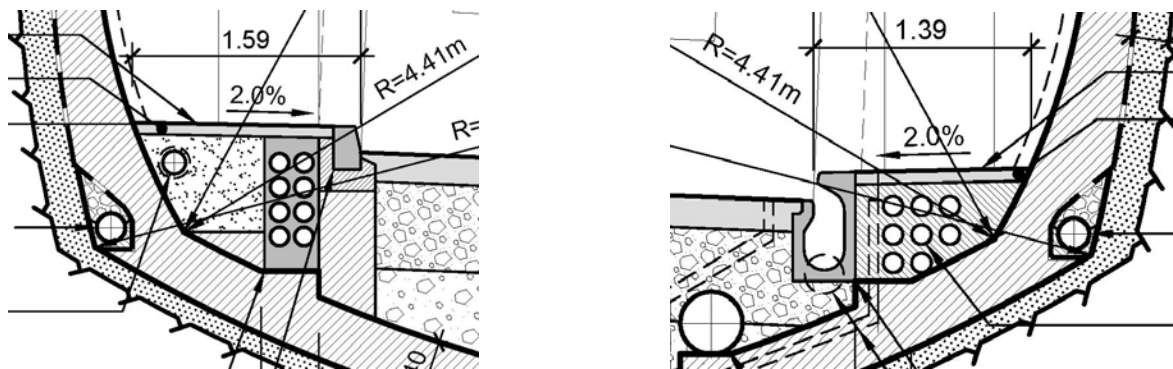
Skizze Bankett Nord (links) und Bankett Süd (rechts) (siehe auch Plan TU.101)
